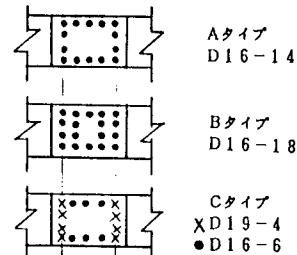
支持部材鉄筋 (A_{s2}) の配置状況
